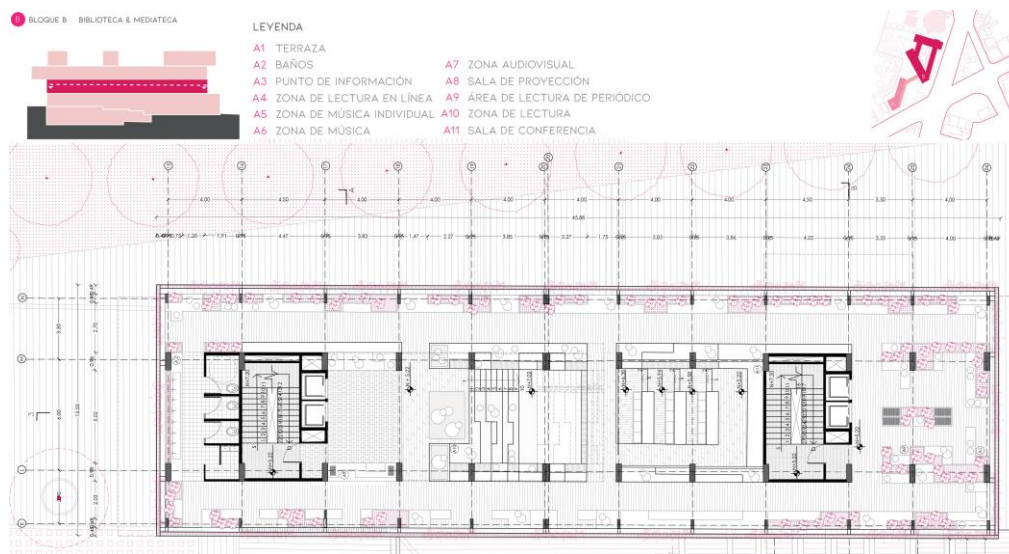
Planta II – Bloque B2. Fuente: (Andrade, 2019).
